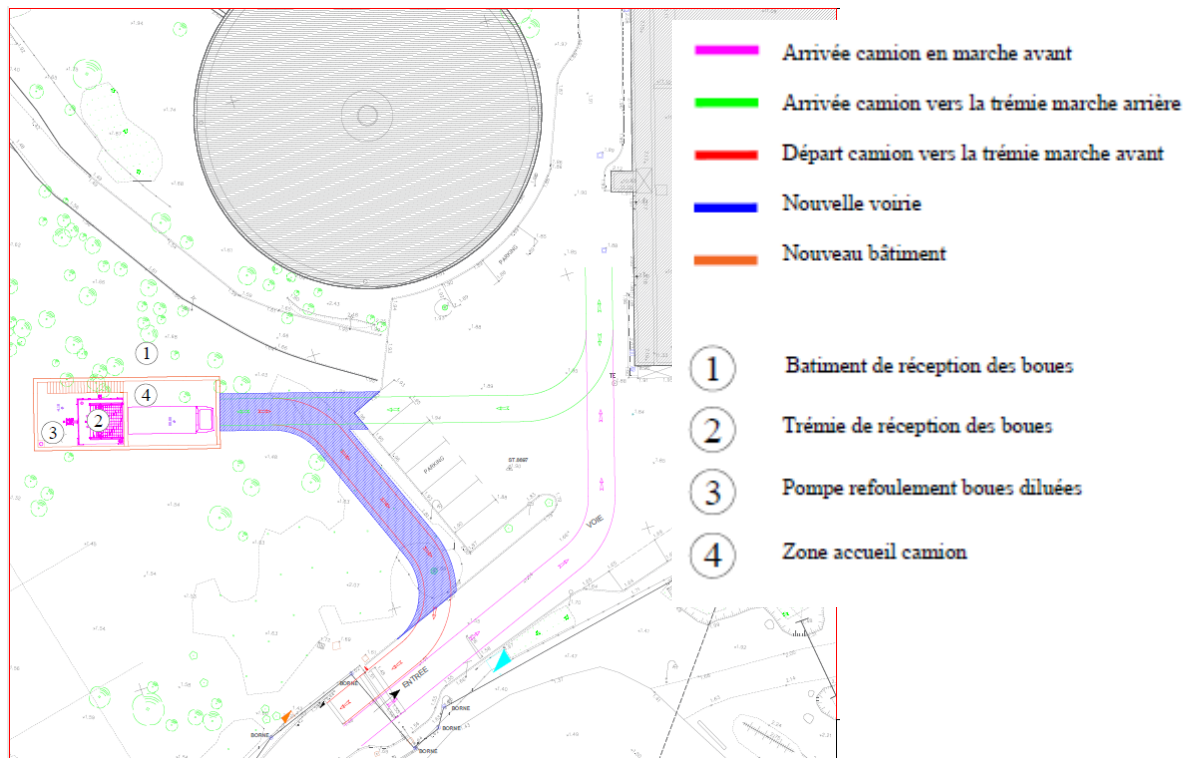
Plan d'implantation du bâtiment de réception des boues extérieures
